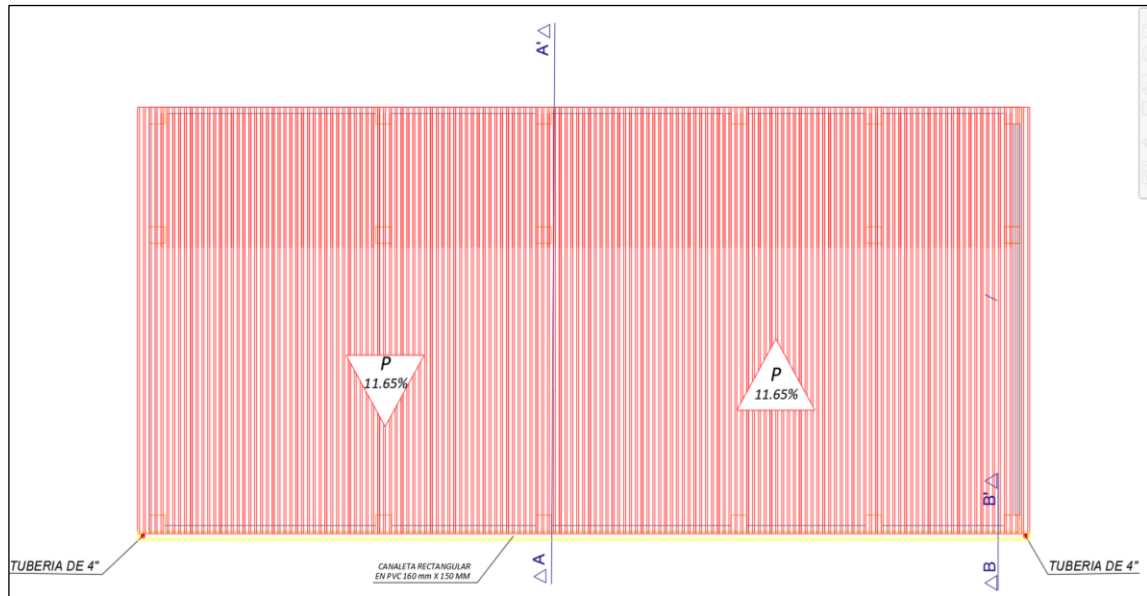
Vista en planta de tejado de la estructura 3 del Centro de Desarrollo Infantil.
